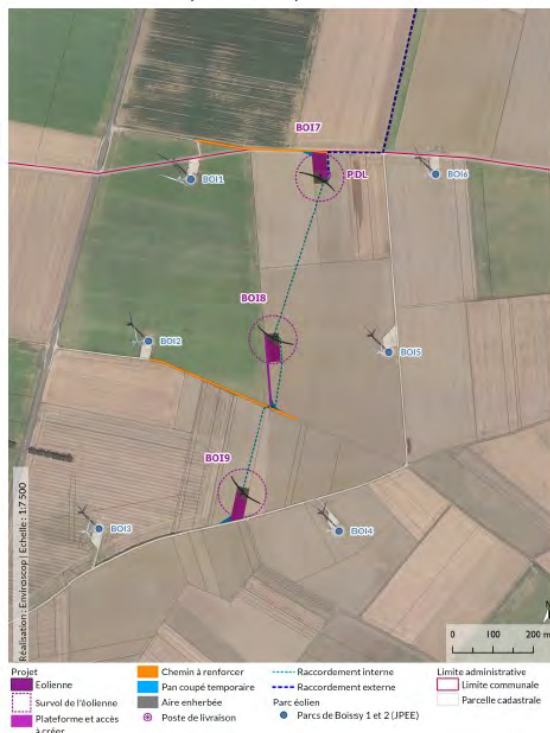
Plan d'installation du parc éolien (étude d'impact, p.162)
